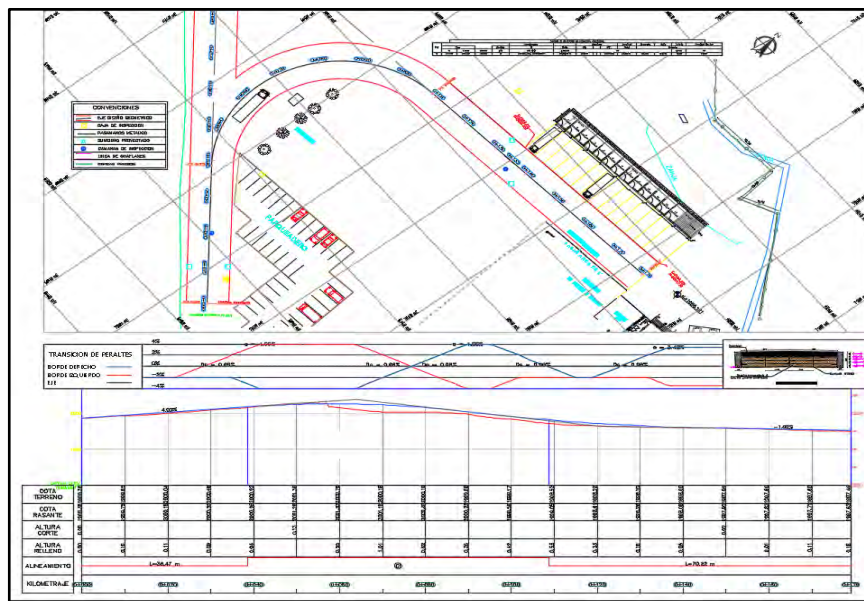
Plano definitivo planta – perfil acceso plaza de ferias Guachucal – Nariño.
